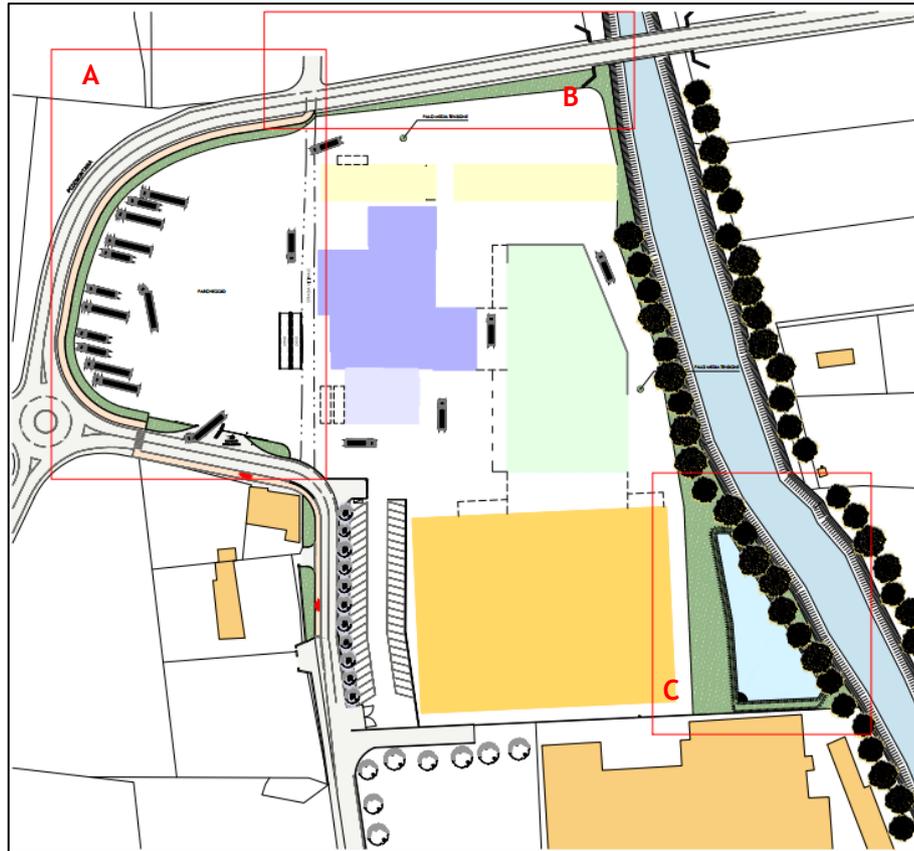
DIVISIONE DELLE AREE A VERDE, OGGETTO DI SINGOLE PROGETTAZIONI
